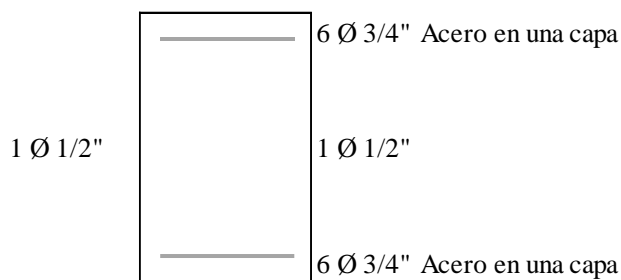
Distribución del Acero longitudinal de VP-202 (40 x 90) - Sistema estructural tradicional.
